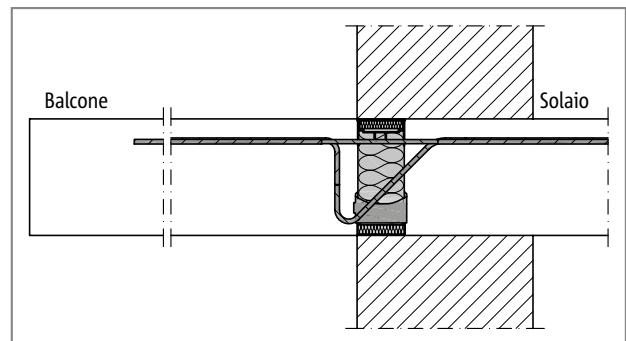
Schöck Isokorb® tipo K, raccordo del balcone con muratura monostrato isolante
